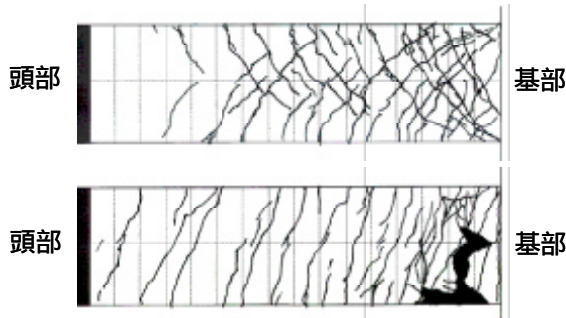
曲げ卓越型 - 上面(上段)及び側面(下段) ひび割れ図(No.3)
